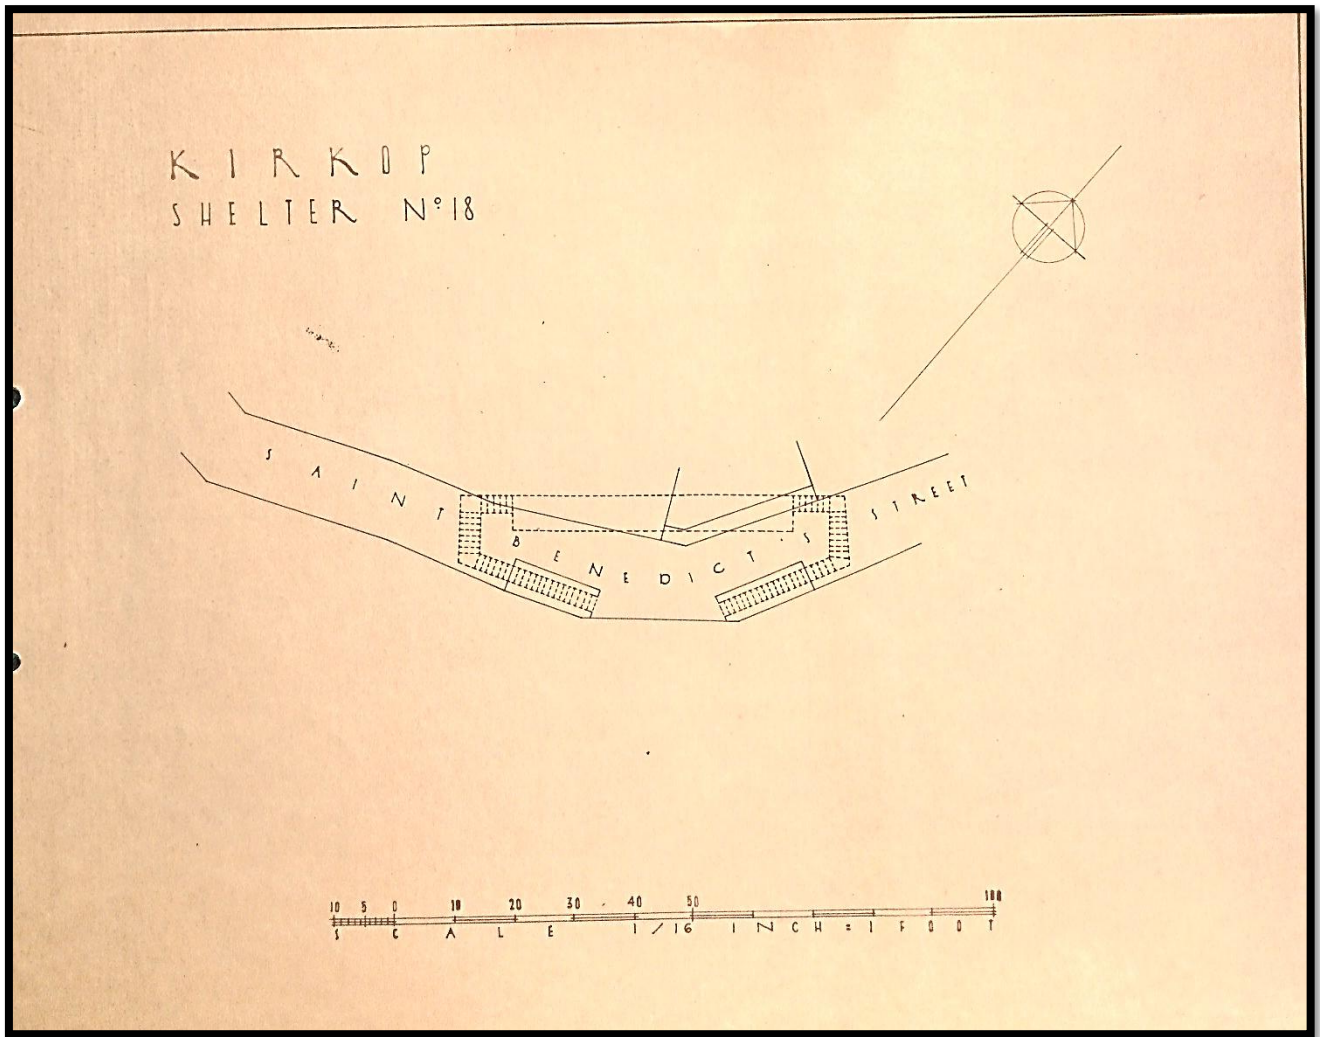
Planta do Abrigo nº18 "Saint Benedict's Street."
